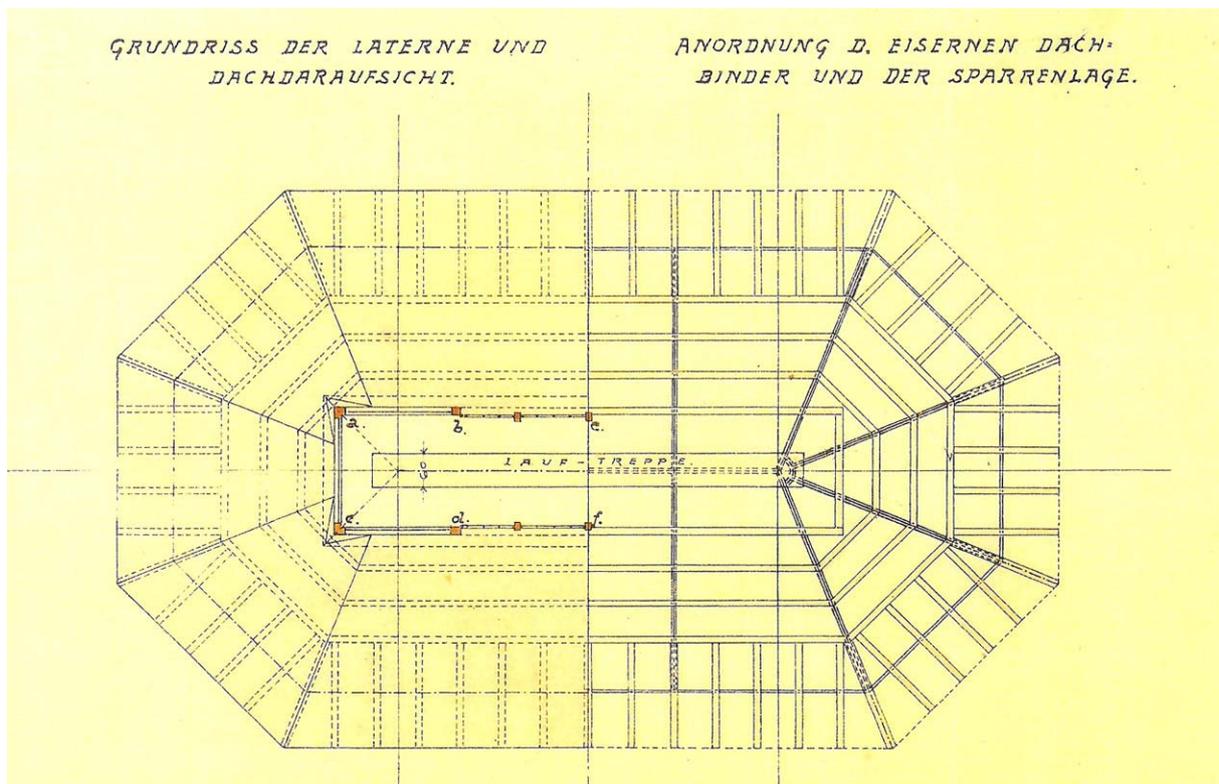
Grundriss der Laterne und Dachdraufsicht, Plan Mai 1903
